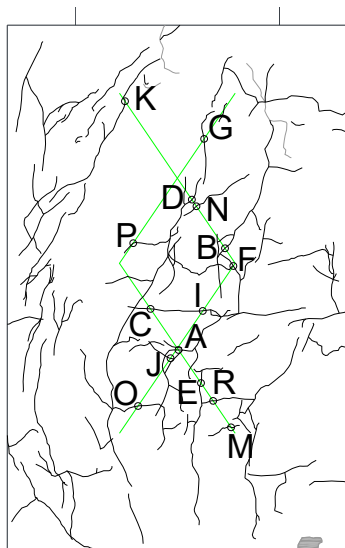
パイルキャップ危険断面位置ひび割れ幅測定位置 (試験体 D-4 正載荷)
